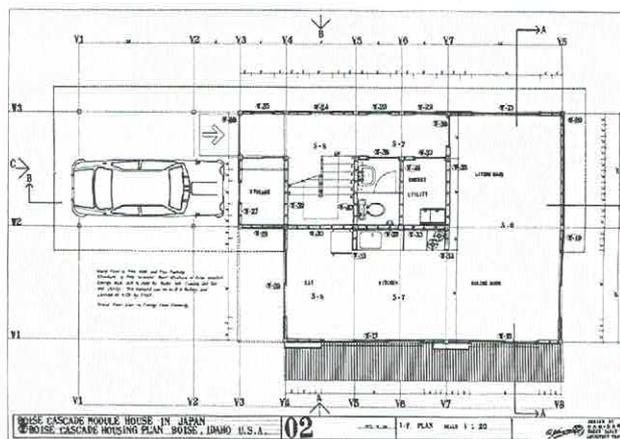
Osamu Ishiyama. Plano enviado a Estados Unidos para la construcción de la primera vivienda. Fuente: *Shinkenchiku*.
